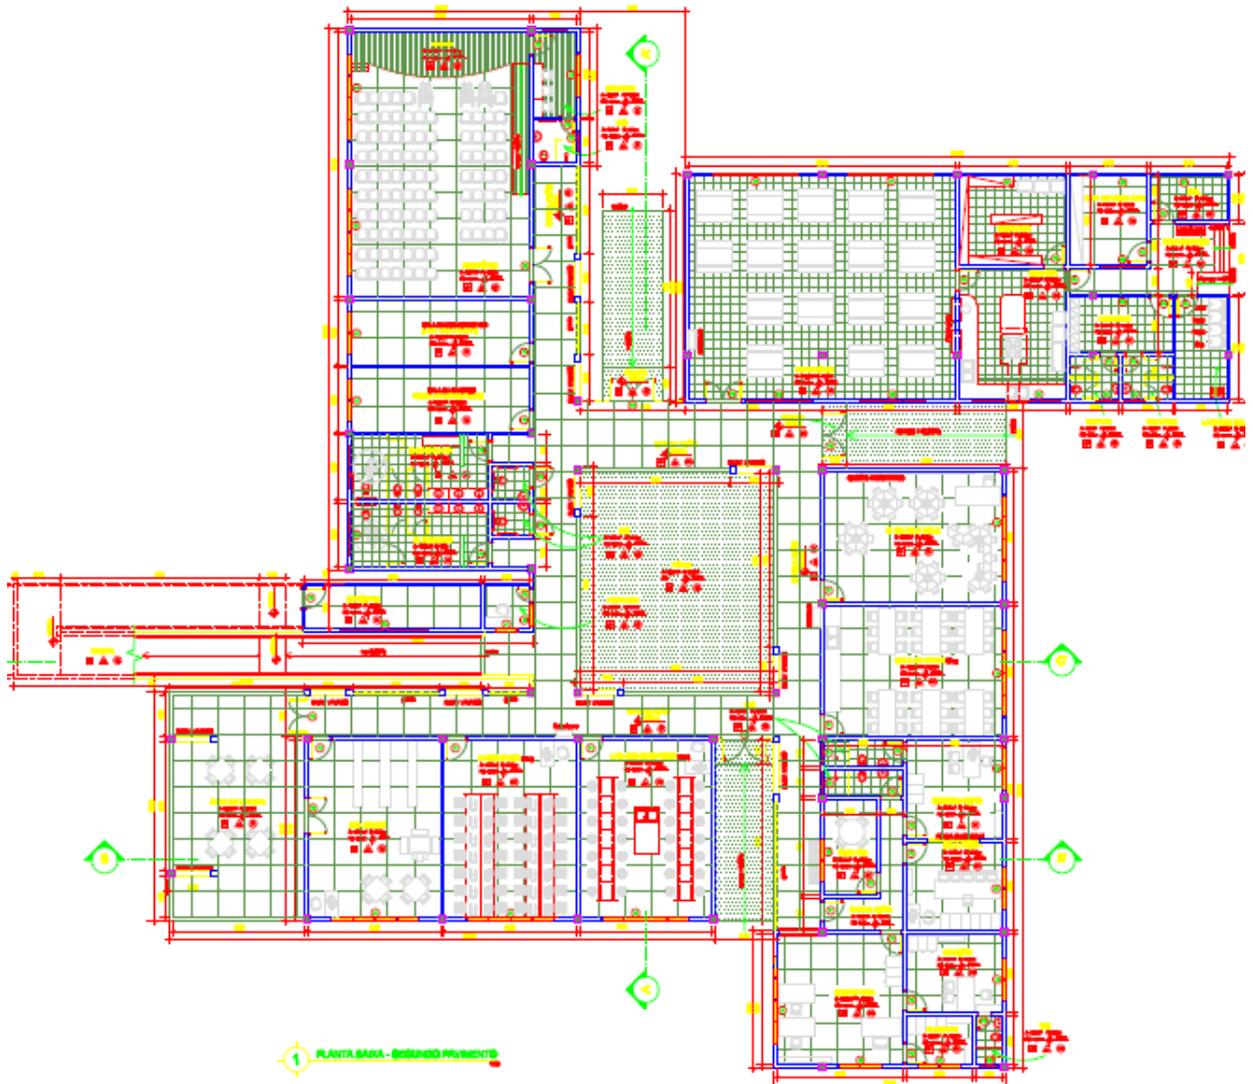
Projeto CE Erich Walter Heine. Pavimento Térreo.
